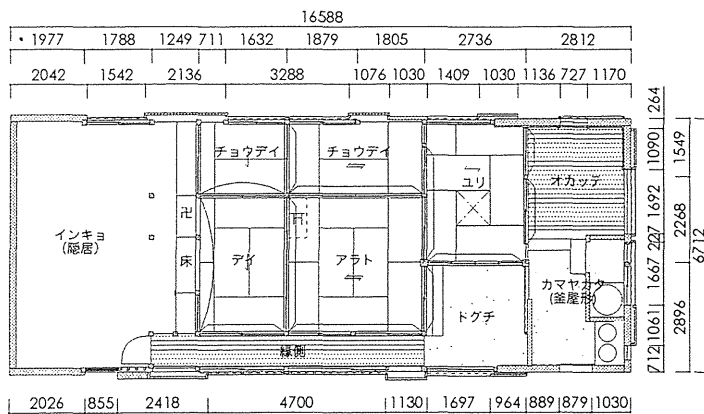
積み石のオーヤ平面図 (S=1:200) (通し番号 2)
